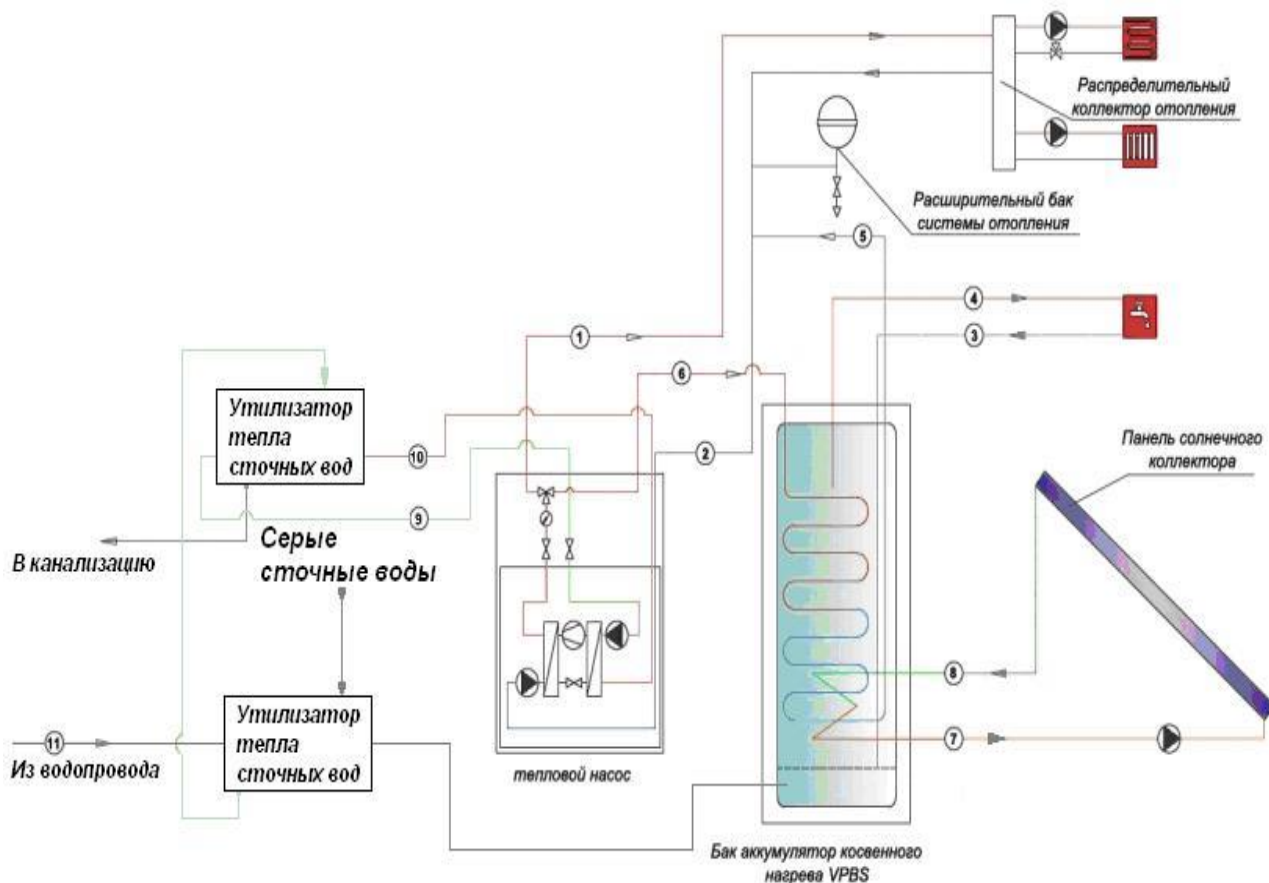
Комбинированная схема теплоснабжения жилого здания (вариант 3)
